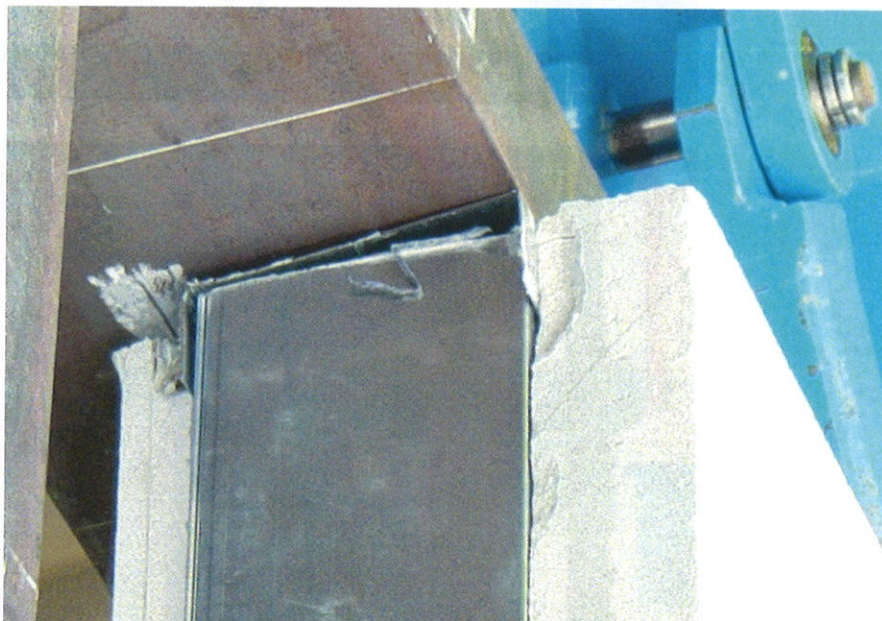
試験体の状況 (+1/75rad. ALC板のはく落:)
